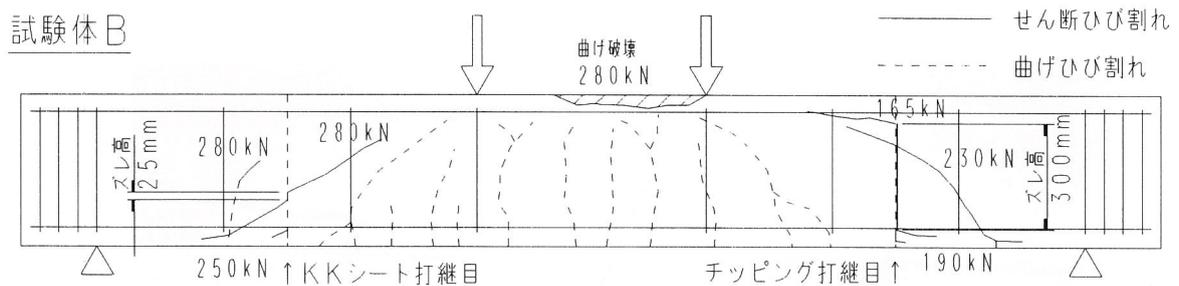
ひび割れ状況 (試験体 B)
